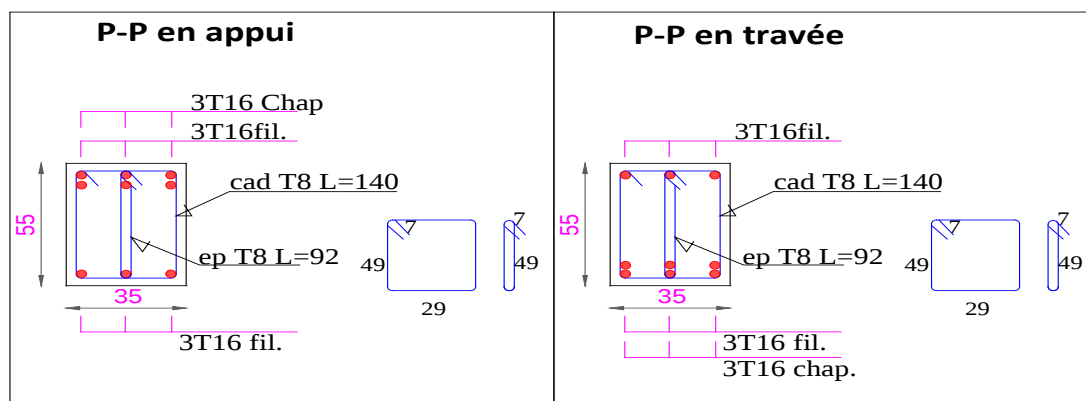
Ferrailages de la poutre principale de (35X55).
